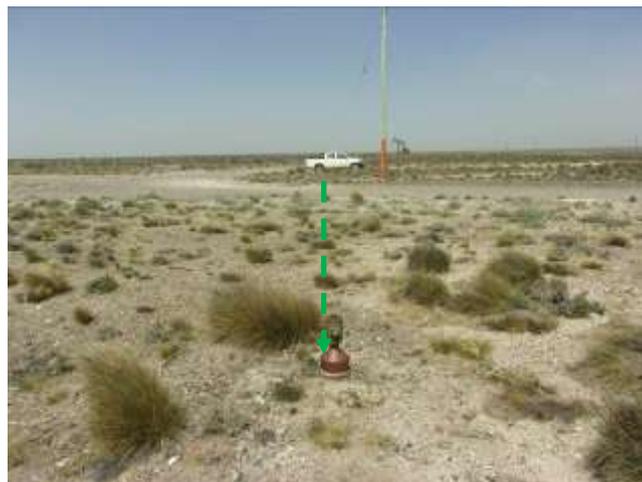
Fin de emplazamiento de línea de inyección en boca de Pozo ENH-338. Foto en dirección S.
